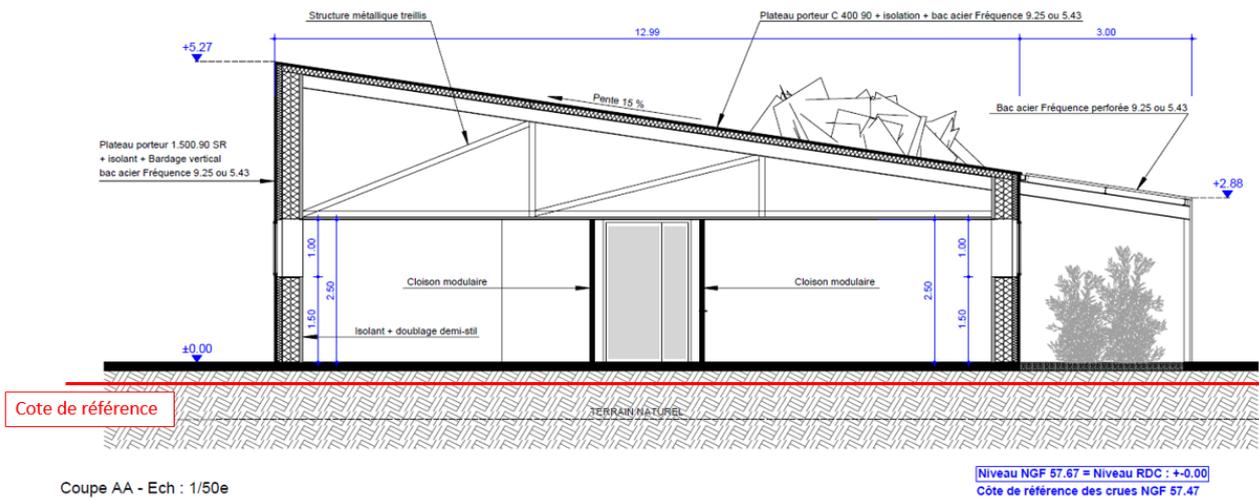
Façade des bureaux – Coupe AA (source : J. Lacombe, 05/11/18)
